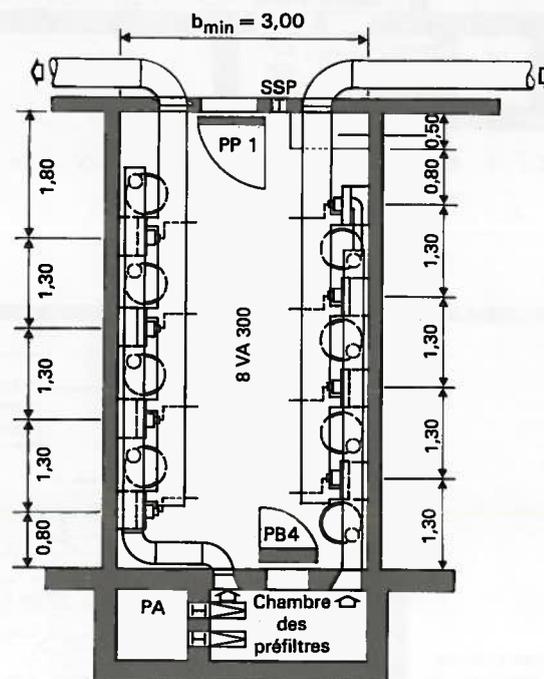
Installation centralisée de VA 300 dans un local de ventilation (plan)
